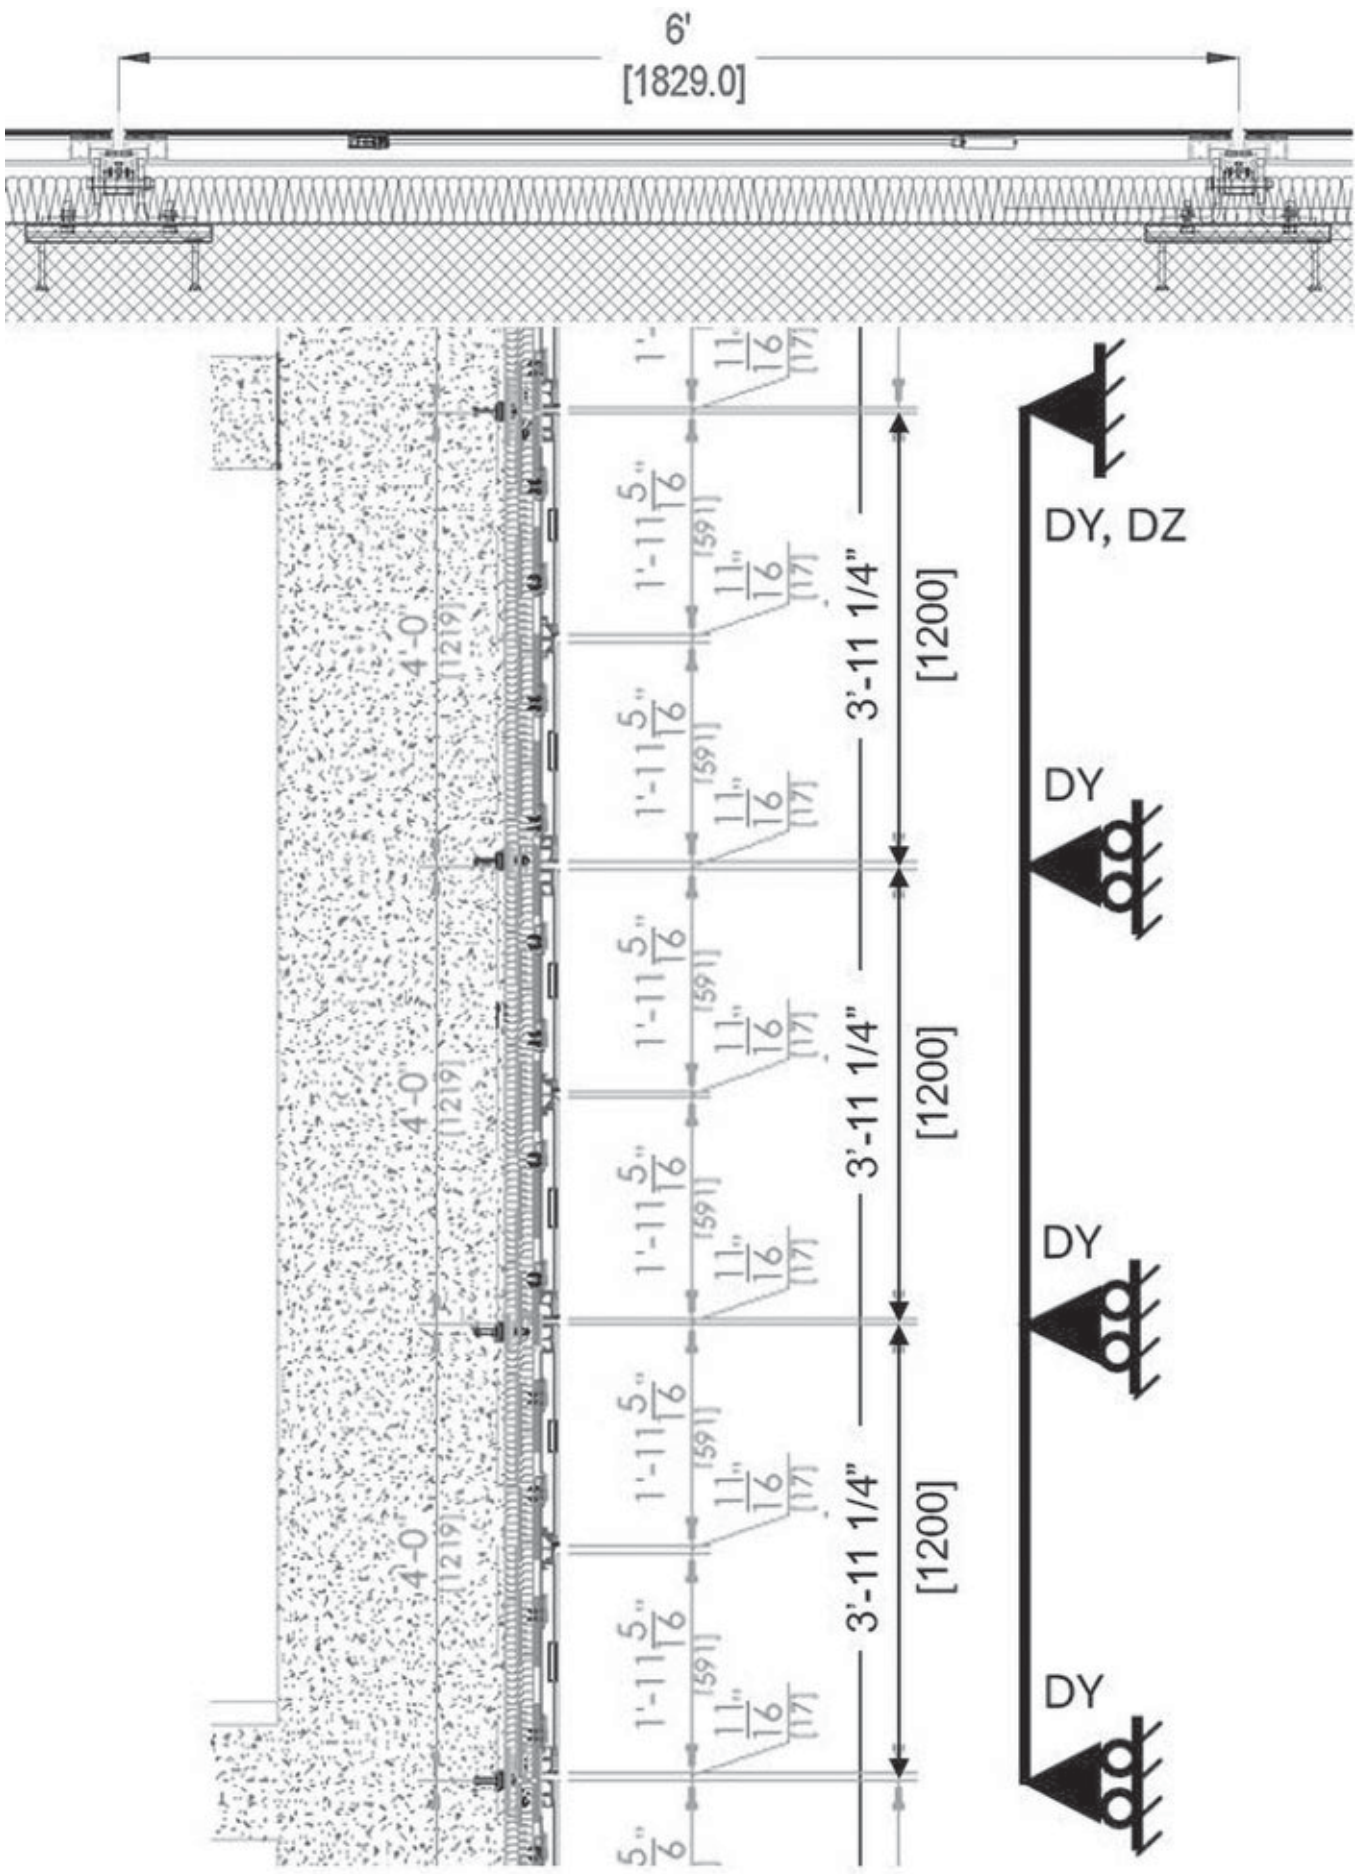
| Sezione orizzontale e sezione verticale con schema statico per carichi fuori dal piano
